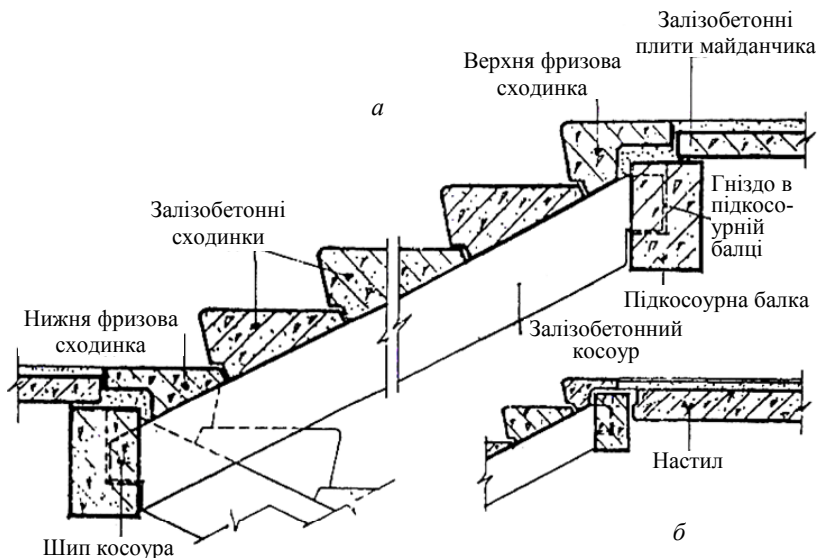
Дрібно-елементні сходи із залізобетонним косоуром:
